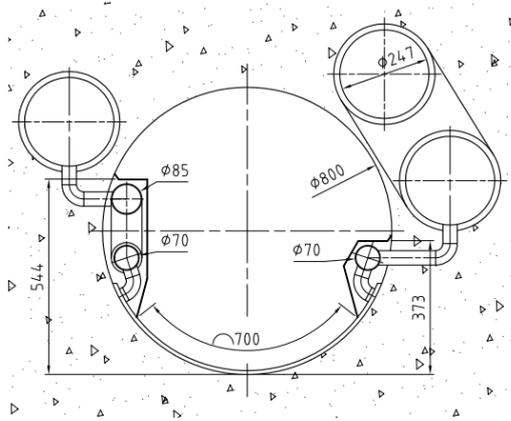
Prinzipskizze Kanalquerschnitt; Befestigung mit Spannbügeln in Kunststoffrohr [Kasag]
